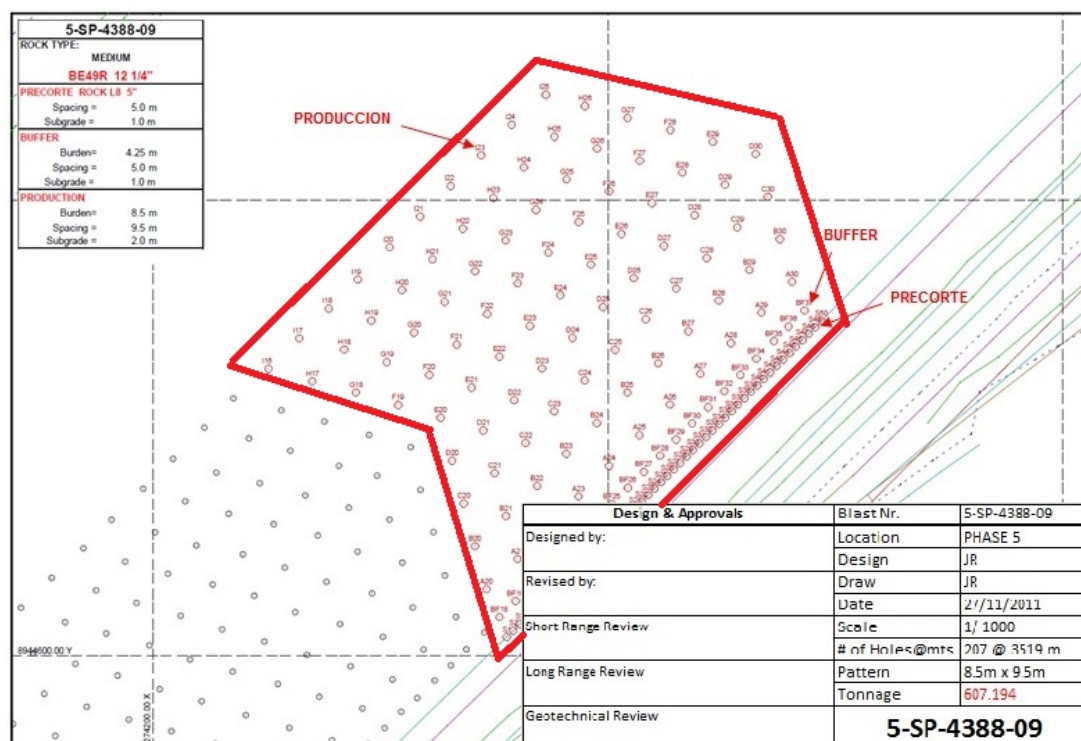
PLANO DE PERFORACIÓN EN LA FASE 5
